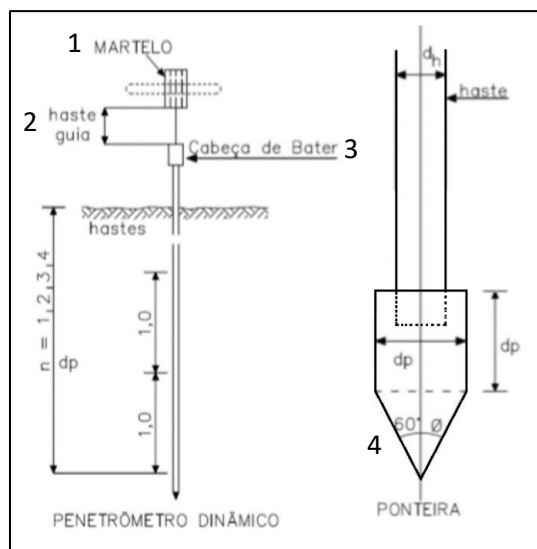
Esquema do equipamento DPL, com detalhes da ponteira (adaptado de Filho, 2010).
